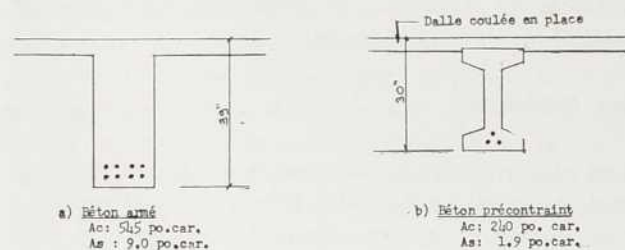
PLANCHER, portée: 37'-0", surcharges: 100 lbs/pi.car. poutres espacées à 12'-0"
